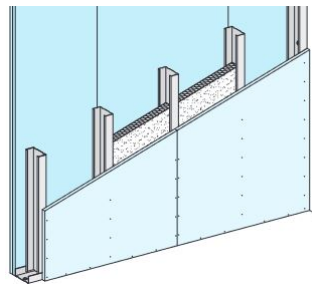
Detalle constructivo de un tabique ligero de placas de yeso laminado (Sistema Knauf W111).
